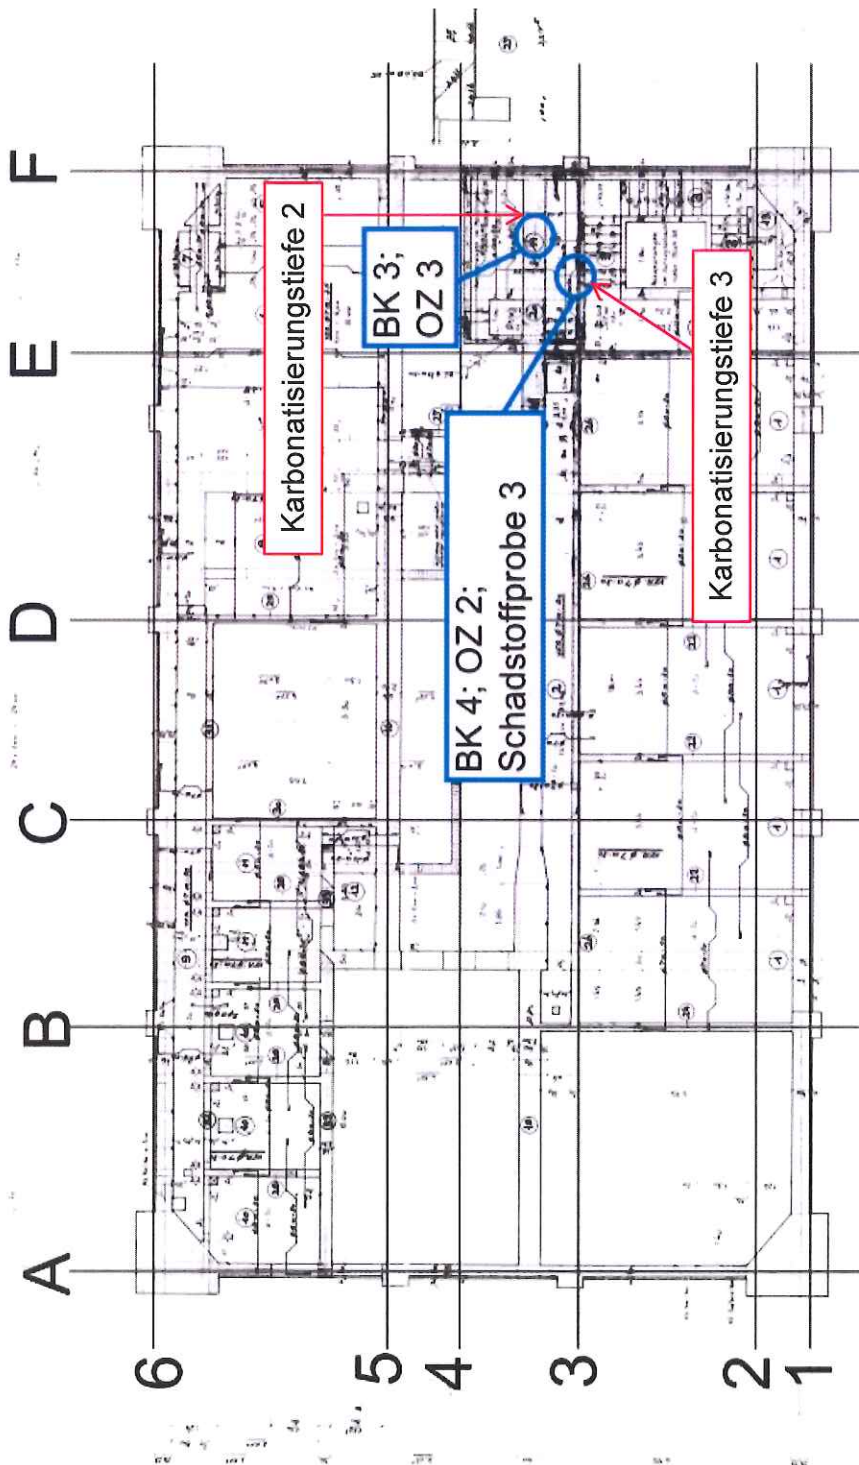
Grundriss Bühne 8 mit Entnahmestellen
